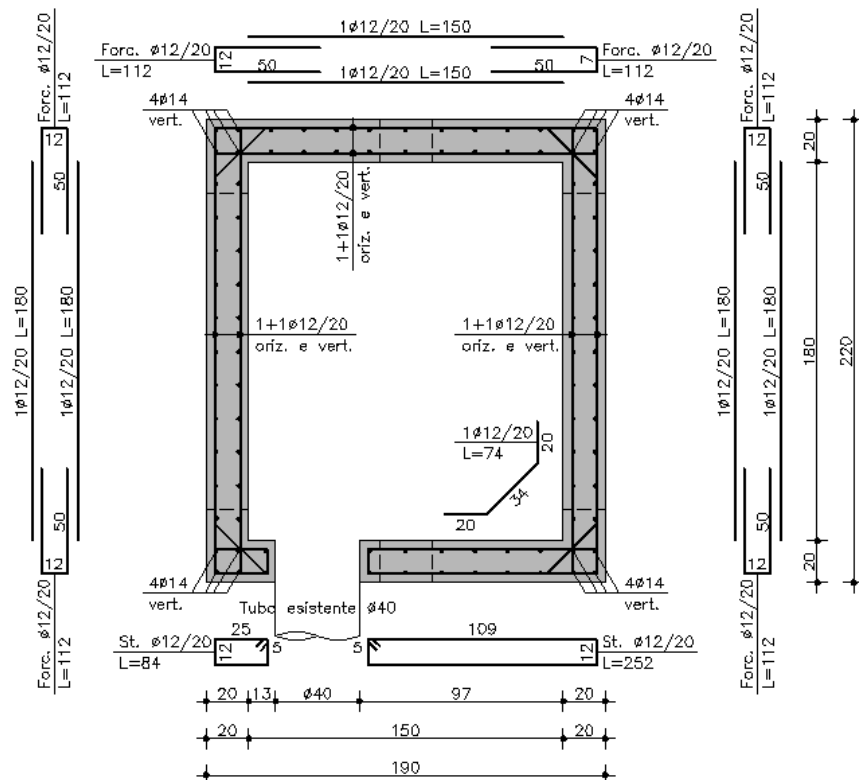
Pozzetto n. 7 - Sezione orizzontale D-D
